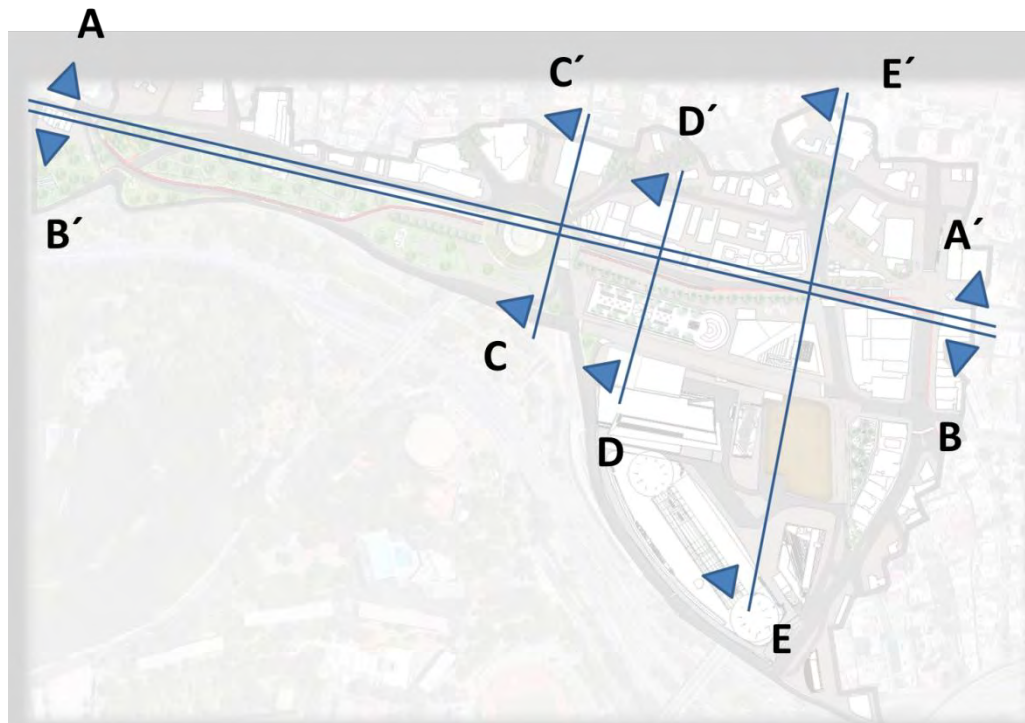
82 Plano de ubicación de perfiles urbanos.
